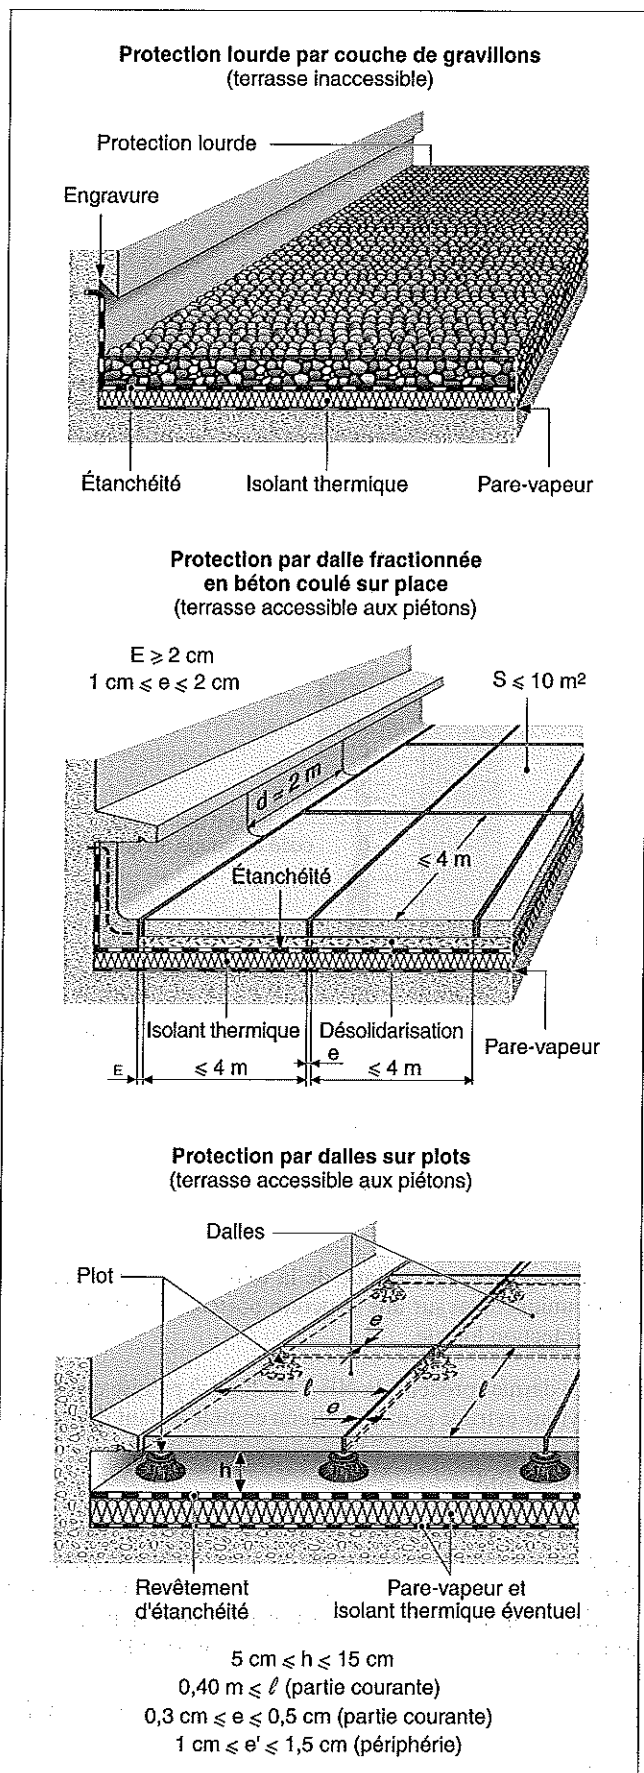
Étanchéité avec protection rapportée.
